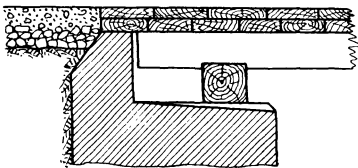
Tragbalken auf massivem Widerlager mit Luftschlitz vor den Balkenköpfen.
